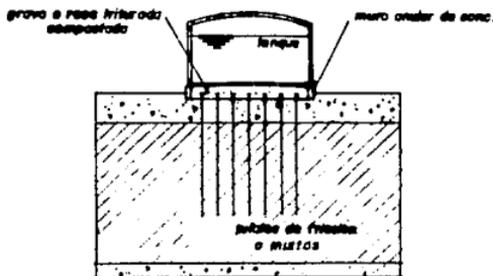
Cimentación Flexible sobre Pilotes de Fricción o mixtos
